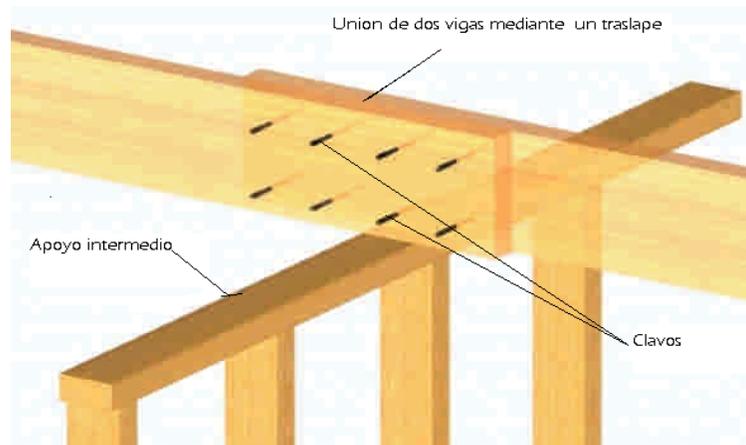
Empalme unido mediante clavos, apoyado en un muro intermedio.
